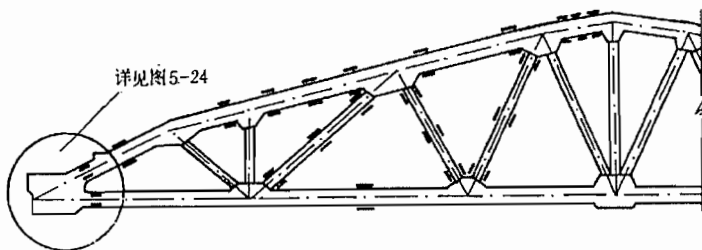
9m 柱距 24m 跨度预应力钢筋混凝土屋架试验测量杆件内力测点布置
